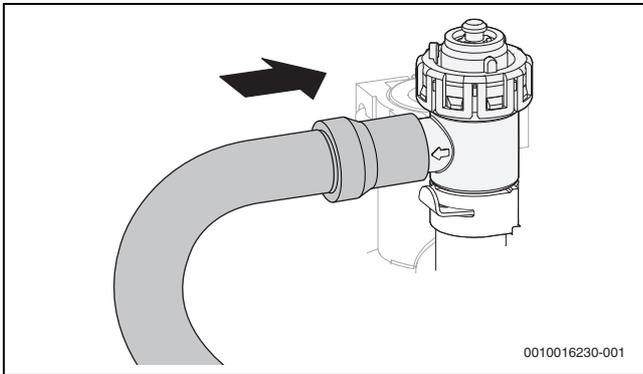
Montaggio del tubo flessibile alla valvola di sicurezza
